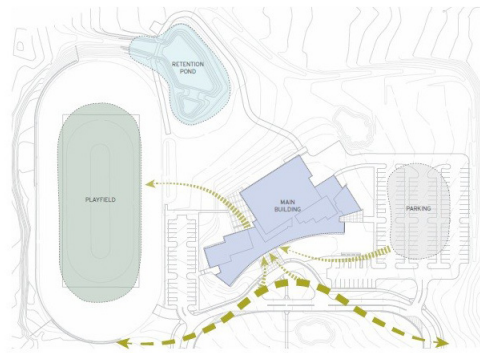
A Planta de Emplazamiento South Tec. Fuente: Arch Daily
